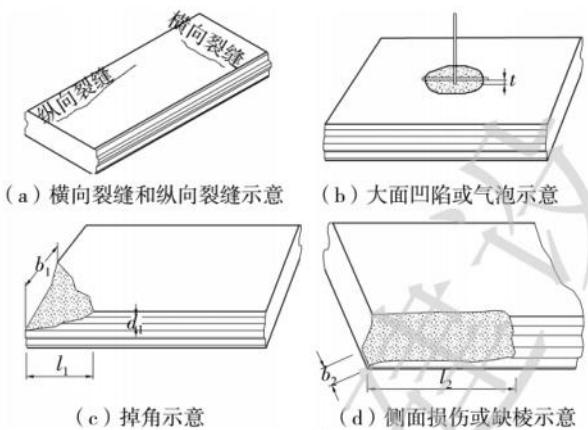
蒸压加气混凝土条板外观缺陷示意图
